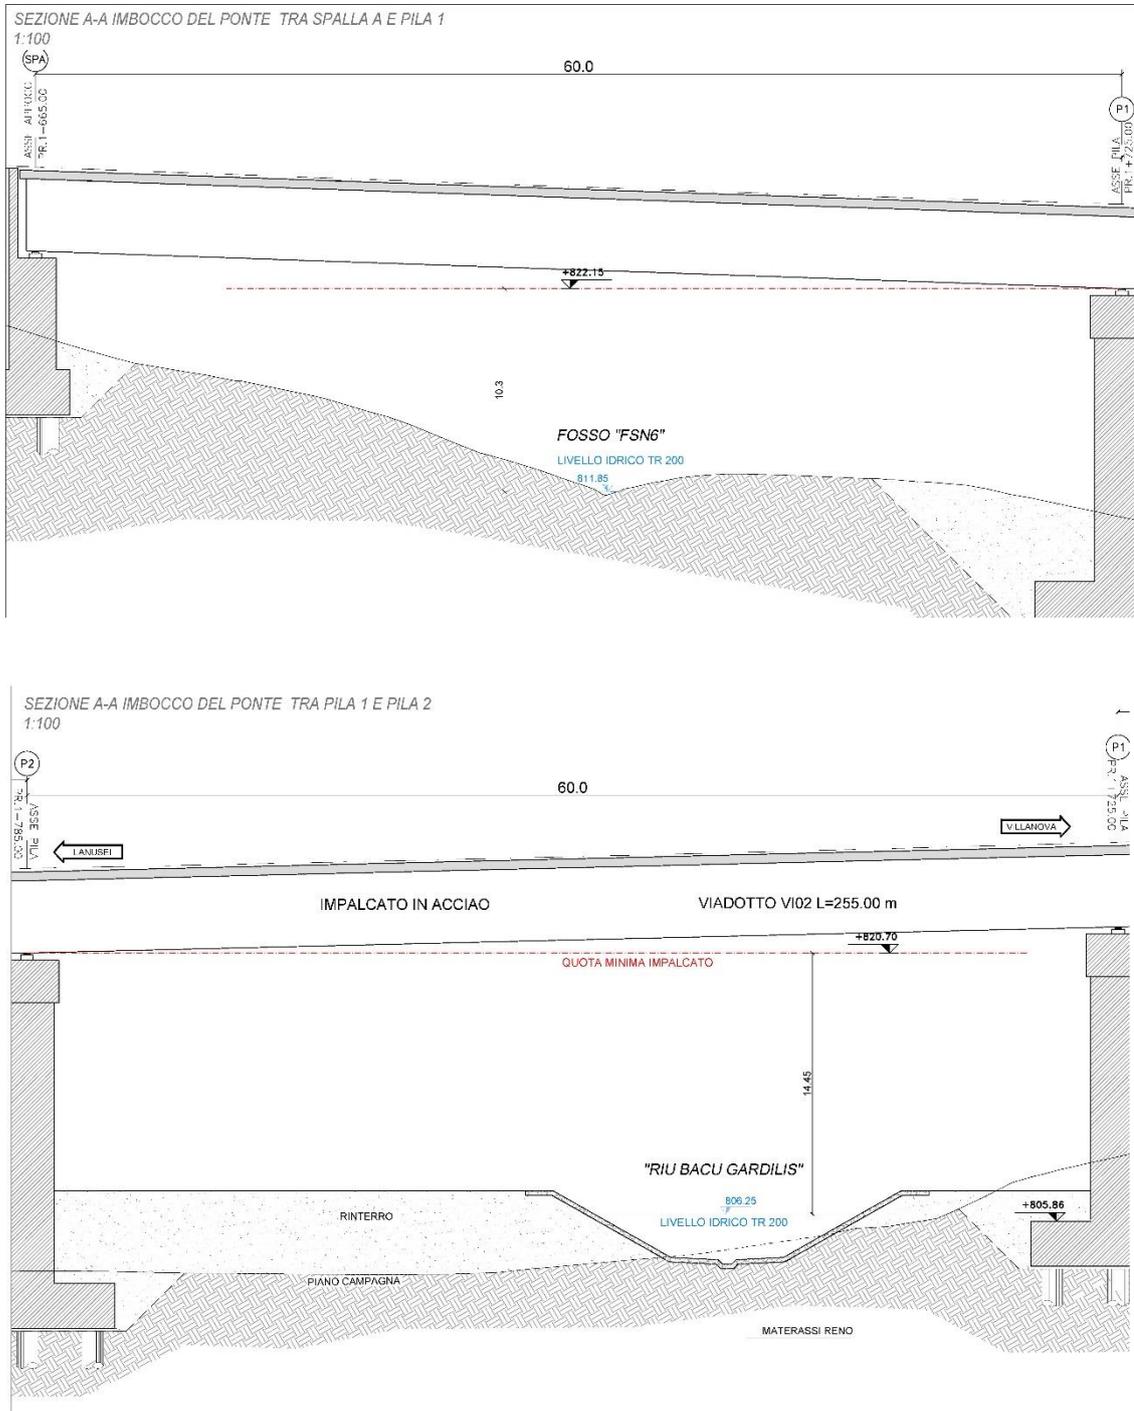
Riu Bacu Gardilis – Sezioni trasversali all’imbocco del ponte.
